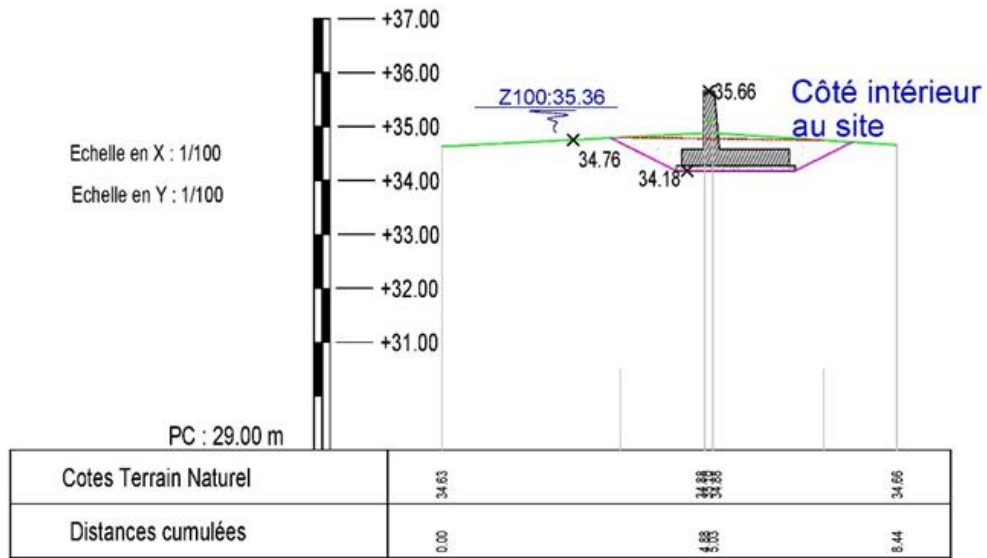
Profil en travers du mur 1 au PK 225.
